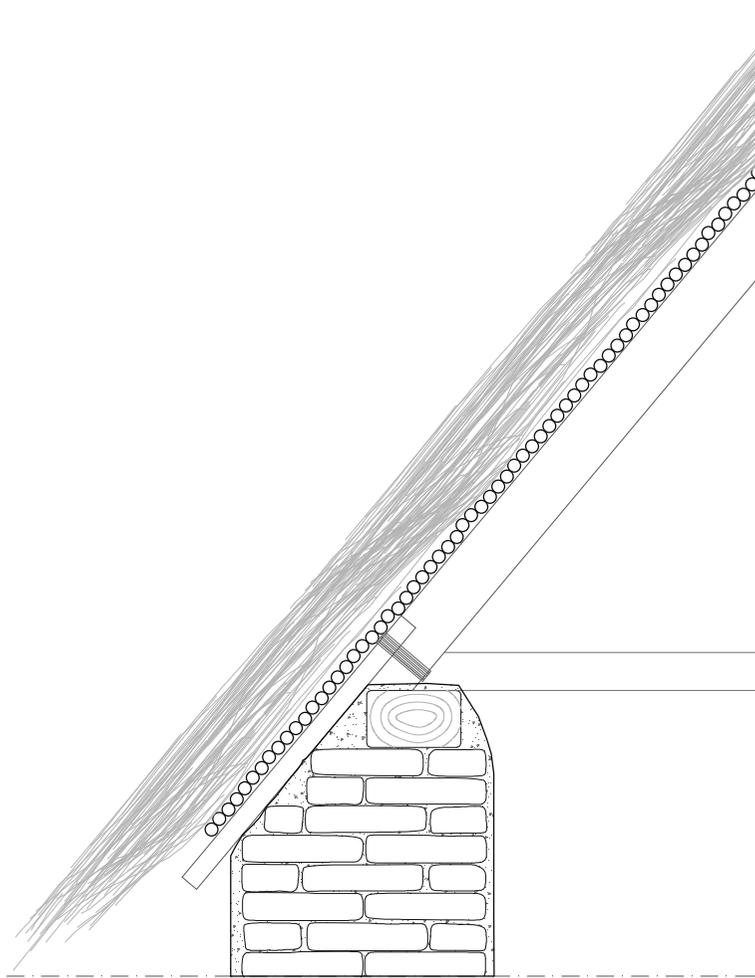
Detalle constructivo cubierta inclinada vegetal.
